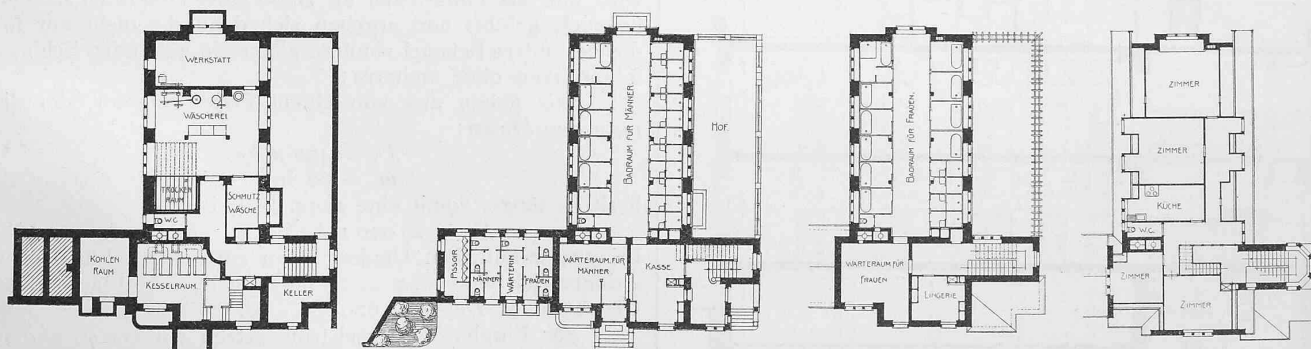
bis 6. Grundrisse vom Keller, Erdgeschoss, ersten Stock und Dachgeschoss. — Masstab 1 : 500.
